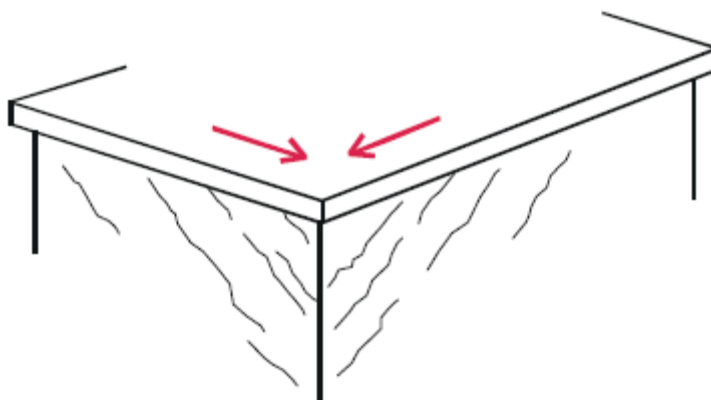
Fissuras diagonais originadas pela movimentação da laje no encontro de paredes
